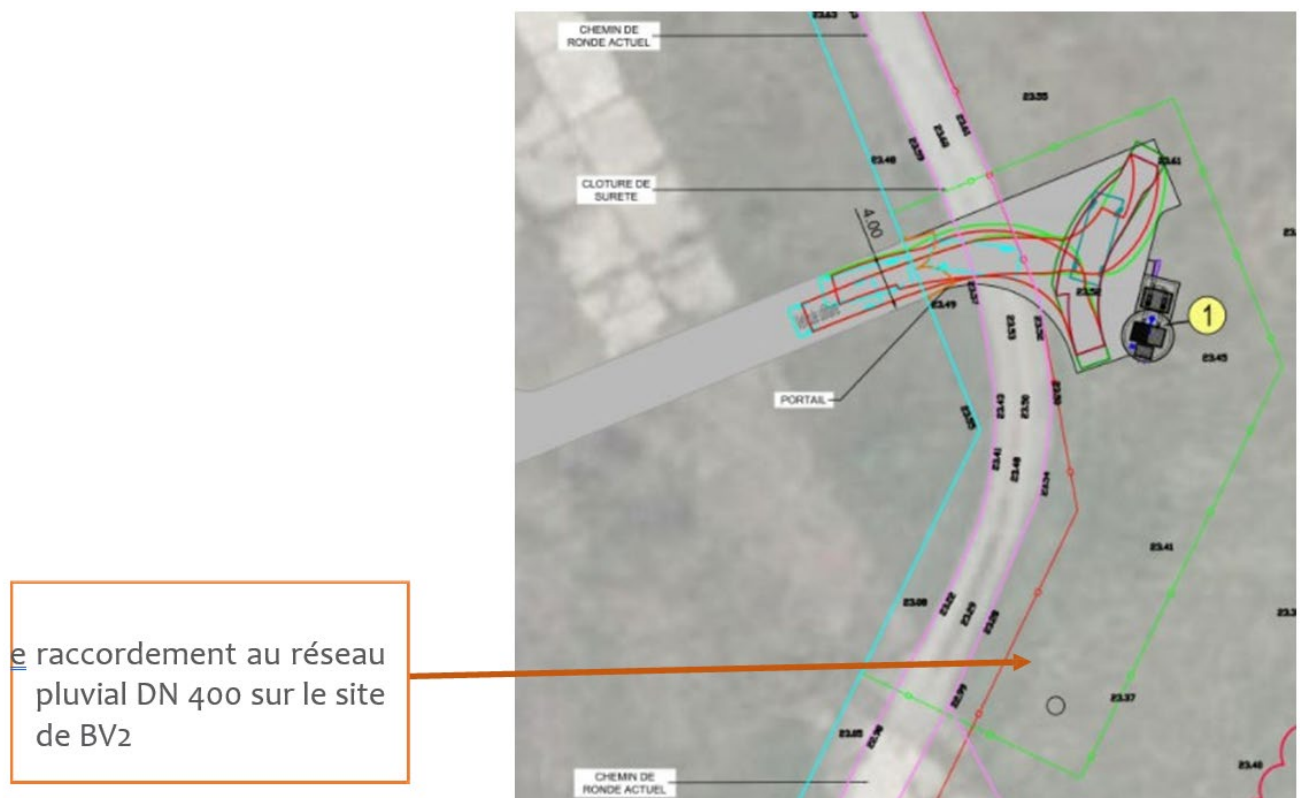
VISUALISATION DU POINT DE RACCORDEMENT AU RESEAU D'EAUX PLUVIALES SUR LE SITE DU BV2
